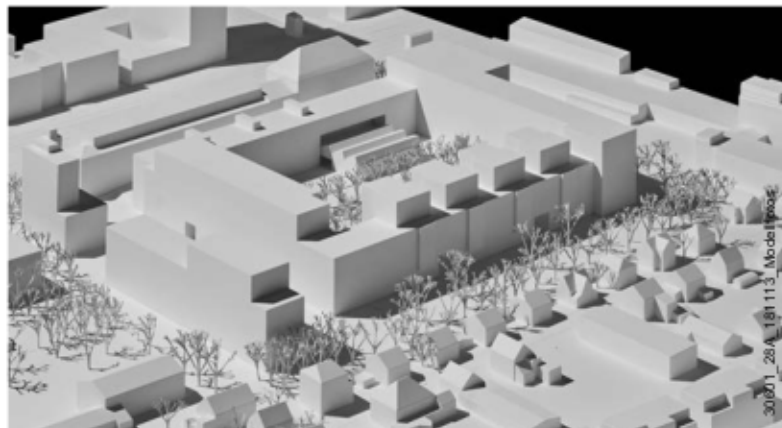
Modellfoto mit volumetrischer Gliederung Baubereich C2 und punktuelltem Höhenakzent Baubereich D1/D2
